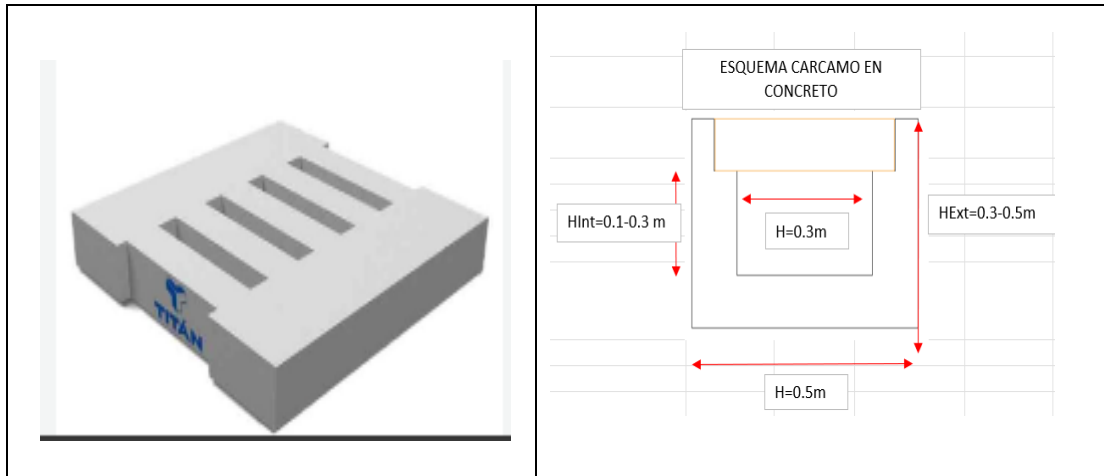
Detalle típico cárcamo en concreto zonas recreativas de canchas y Z. Húmedas.
